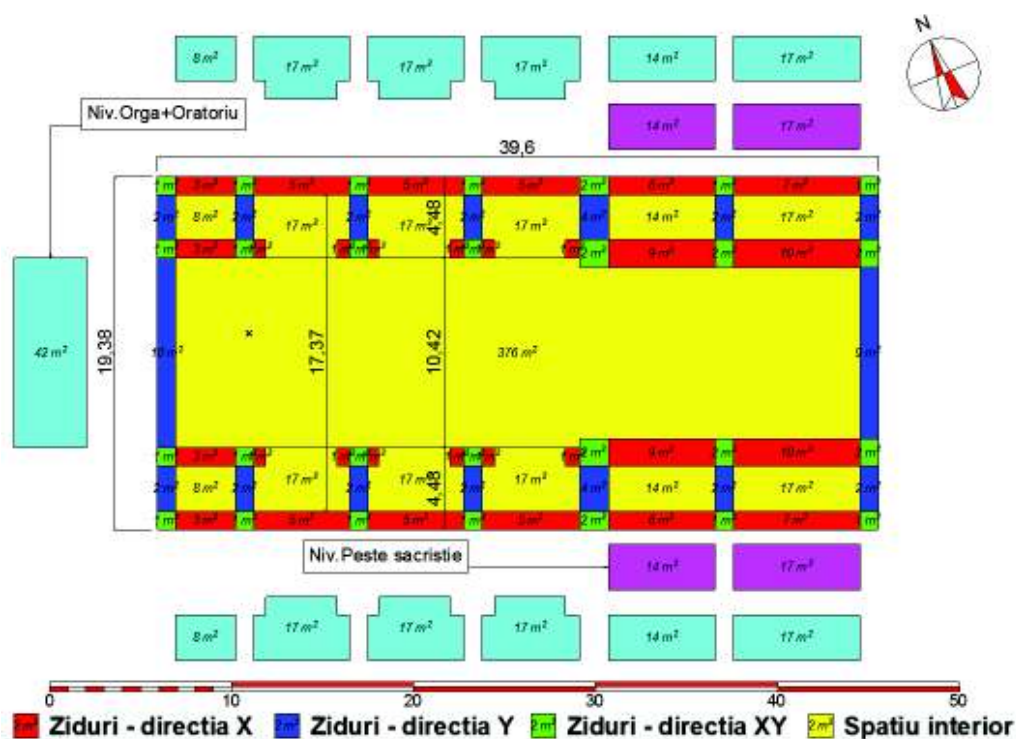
Model planimetric al bisericii iezuite – Tîrgu Mureș
